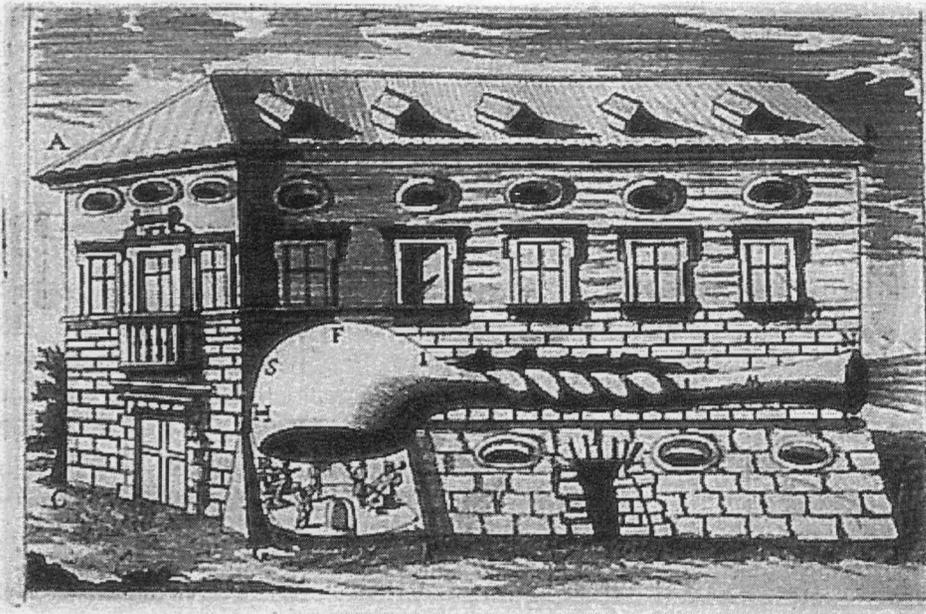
Conduits architecturaux [Kircher, 1673, p. 143]
